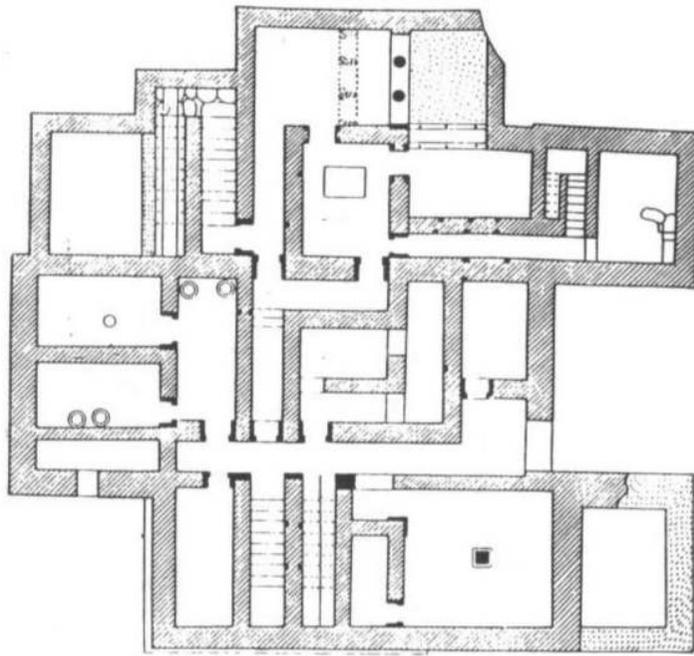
Planta Baixa da Edificação identificada como Casa C de Tylissos. No canto inferior direito da figura pode ser identificado um hall minóico com pilar central de seção quadrada. Conjunto protopalaciano (anterior a 1.700 a.C.), supostamente destruído por um incêndio no Minóico Médio. Referência iconográfica: SCHMID, 1985.
